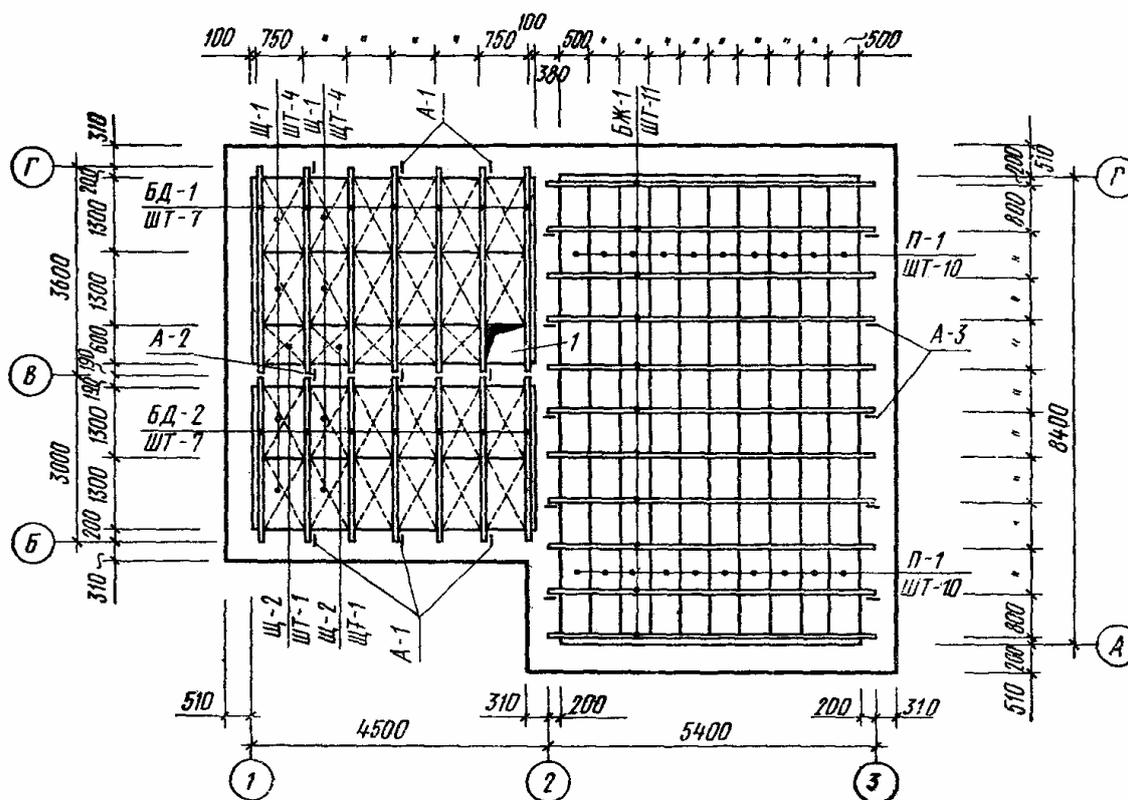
Маркировочный план перекрытия: БД – балка деревянная; БЖ – балка железобетонная; Щ – щит наката; П – плита перекрытия; А-1, А-2, А-3 – анкера крепления балок; 1 – отверстие в перекрытии
